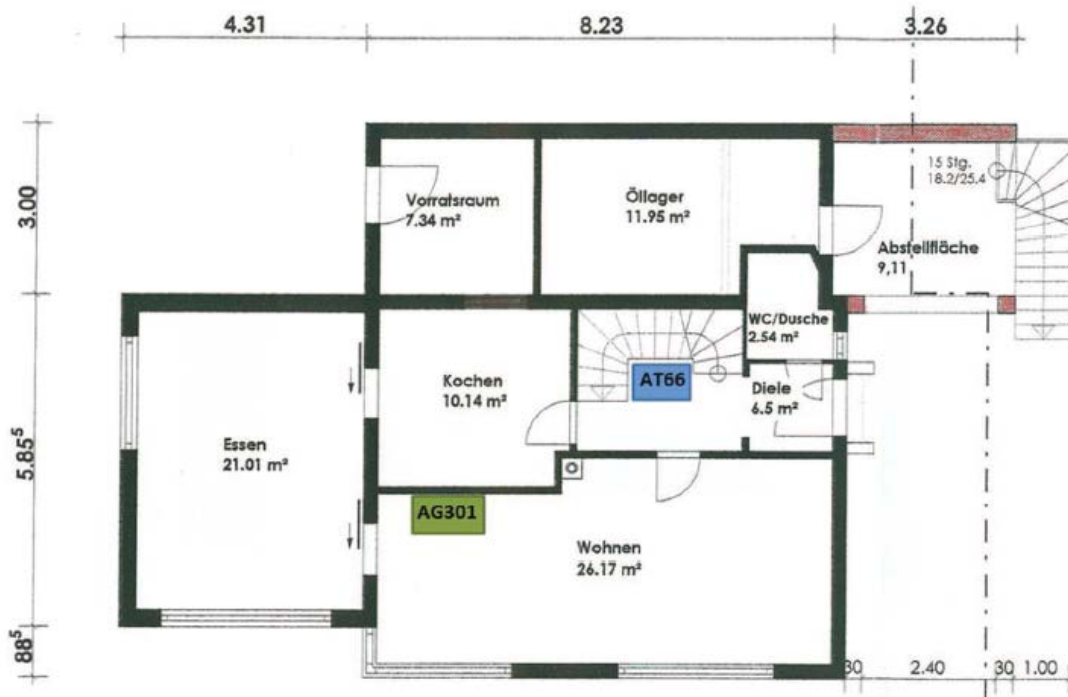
Grundriss des Erdgeschosses des Messobjekts 1.
